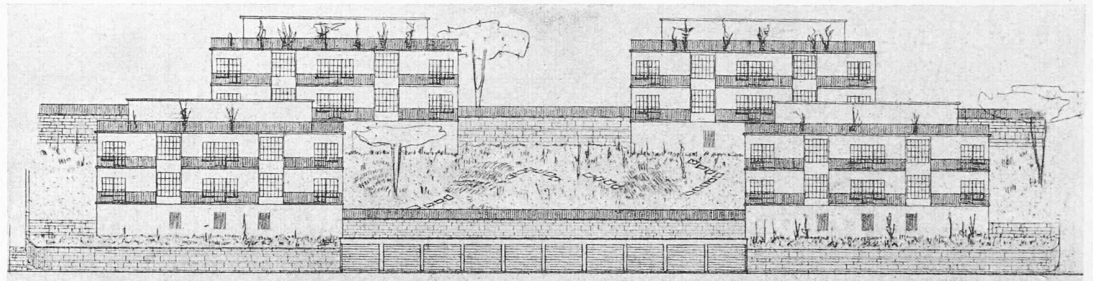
Die ursprünglich beabsichtigte Bebauung mit vier Sechsfamilienhäusern. Gesamtansicht Masstab 1:600
